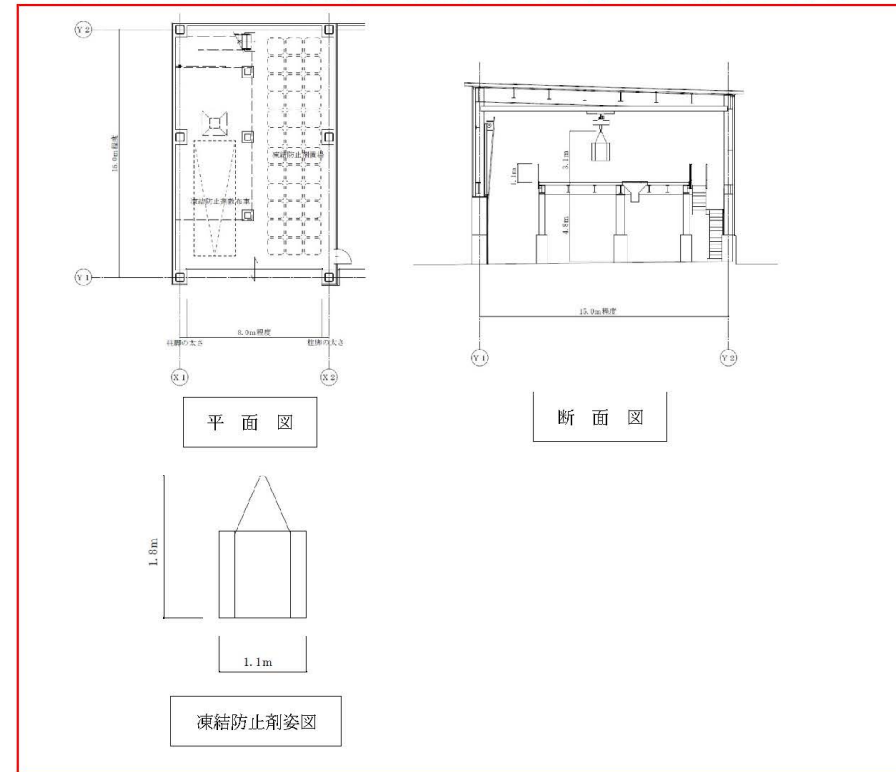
《参考例》単独整備の薬剤庫 平面図及び断面図
